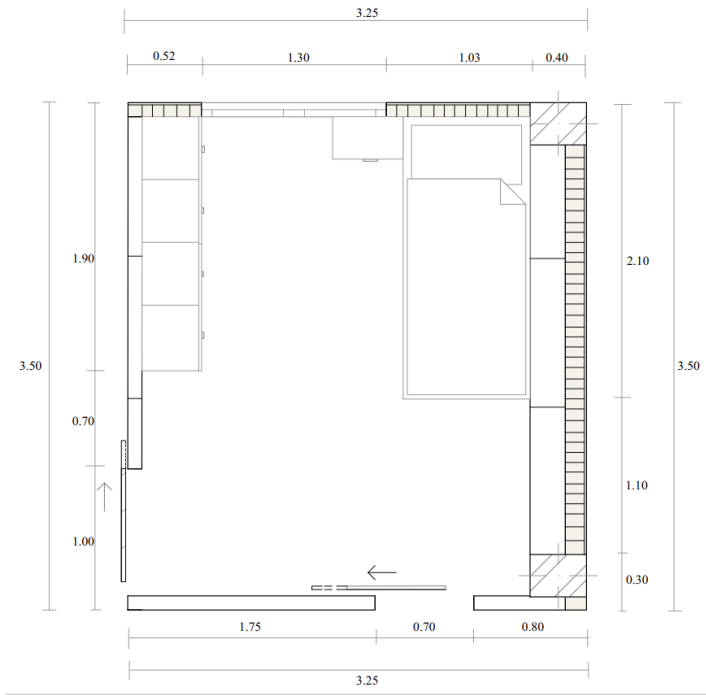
Detalle constructivo de dormitorio de persona invidente- vista en planta
